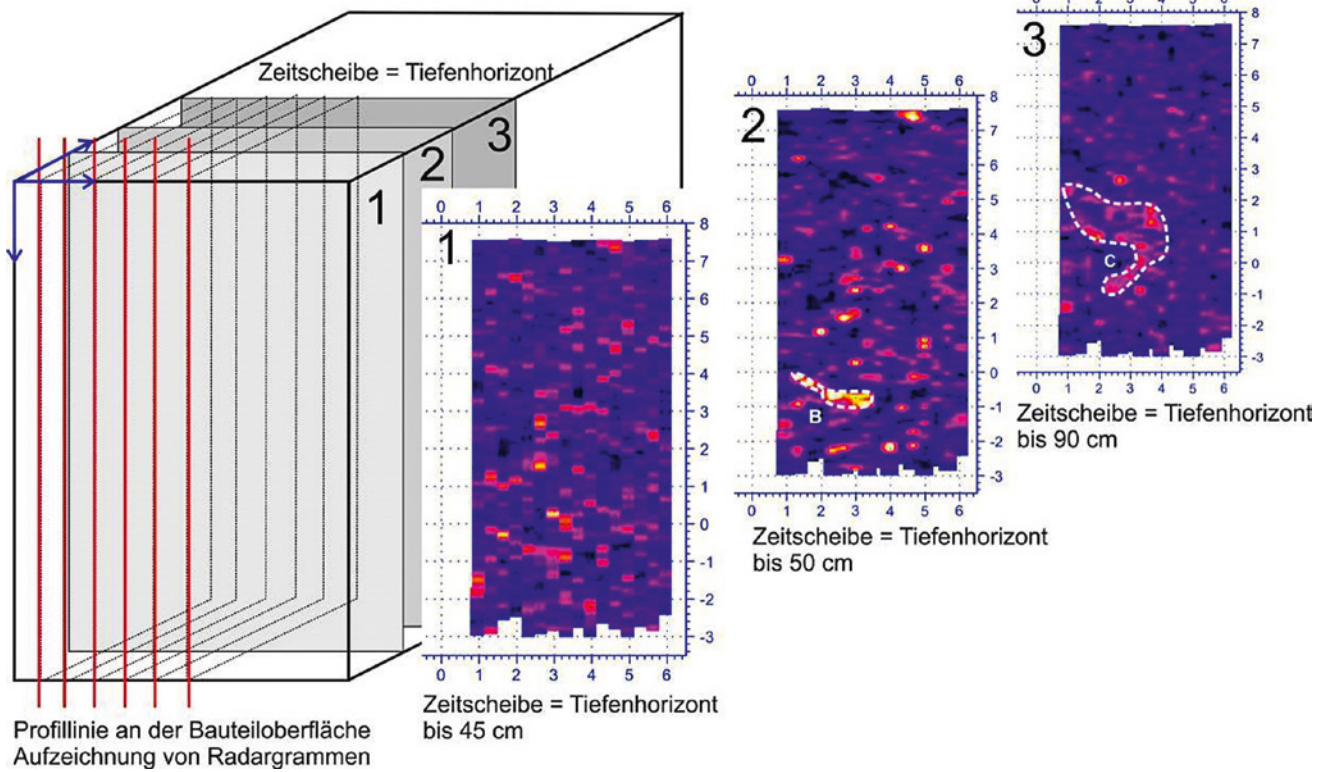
Radarergebnisse als Zeitscheibe (Tiefenhorizont). Dies ist eine grundrissähnliche Darstellung aller Reflexionen in einer bestimmten Bauteiltiefe. Bei den umrissenen Flächen handelt es sich um Hohlstellenverdacht im Bruchsteinmauerwerk einer Talsperre, der über Bohrungen bestätigt worden ist. (Datenquelle: GGU mbH Karlsruhe)
